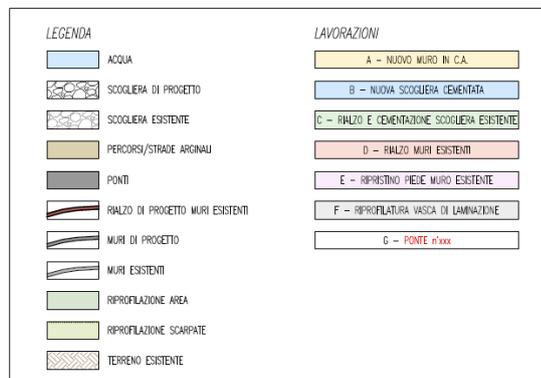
Legenda Tavola 4. Stato di progetto, planimetria generale.
